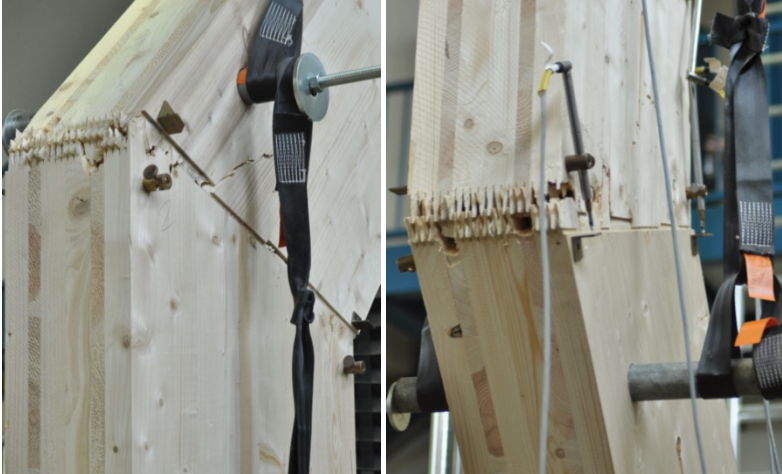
Prüfkörper RE900-90-4 (links) und RE600-105-5 (rechts) nach dem Erreichen der Höchstlast
